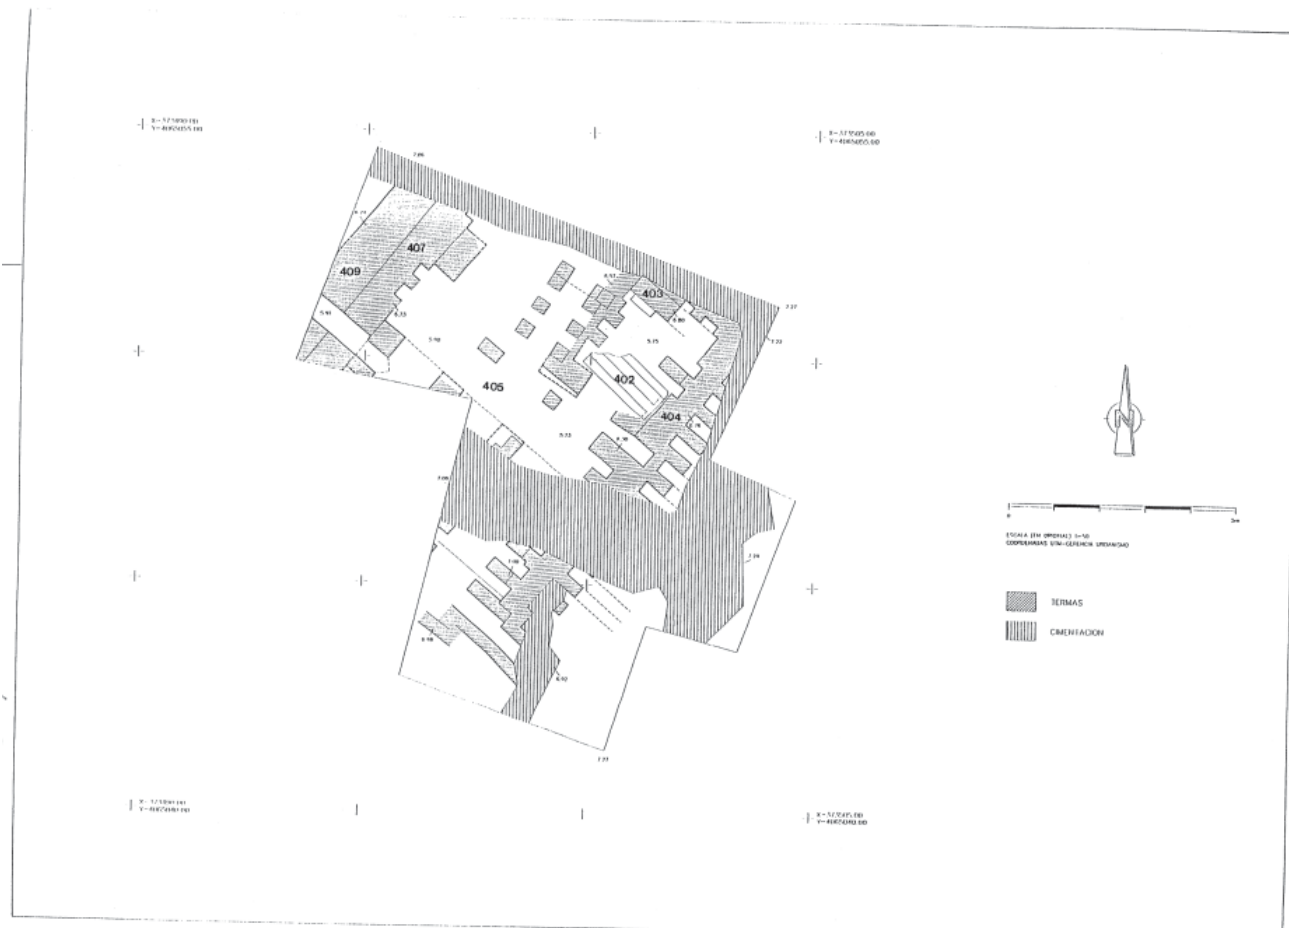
Abadía del Cister. Planta general del edificio termal.
